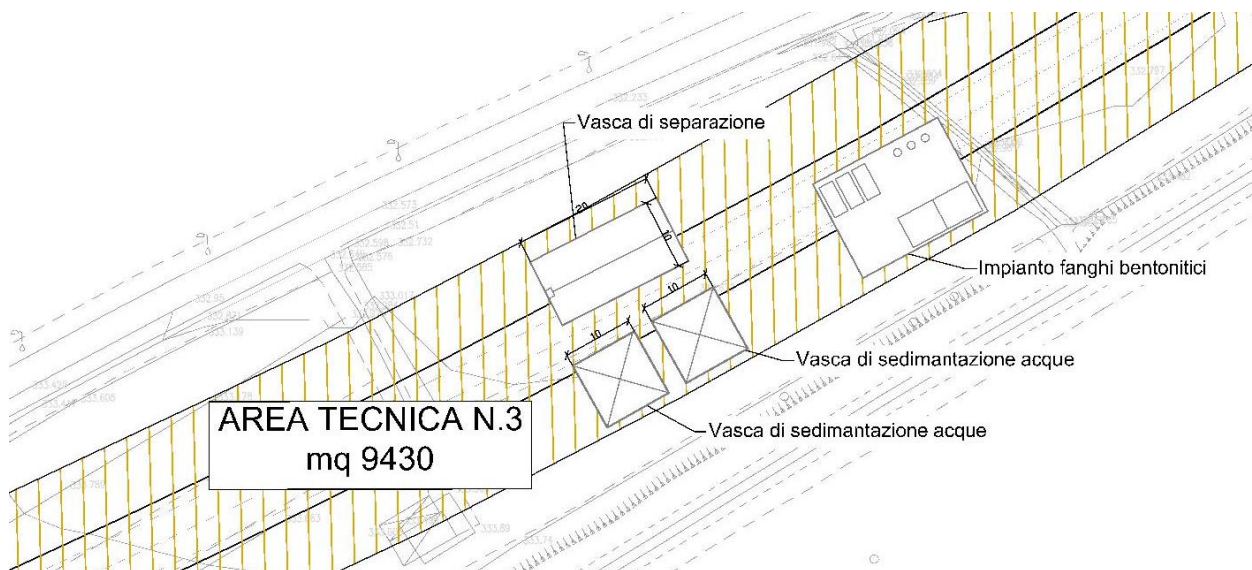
Stralcio planimetria aree di cantiere – Vasche di separazione e sedimentazione fluidi di perforazione
